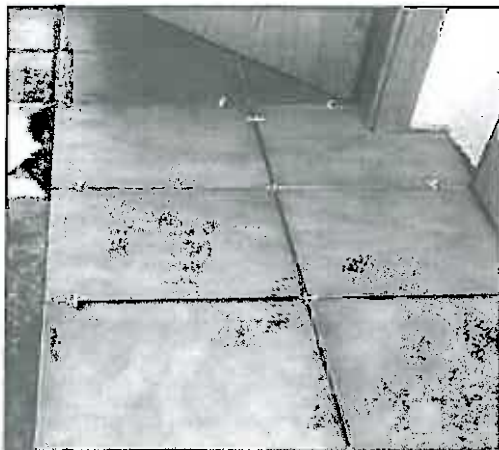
Reparação de pavimento, substituição de pavimento flutuante por pavimento cerâmico Loteamento Municipal da Atalaia, bl.12, r/c. esq.
